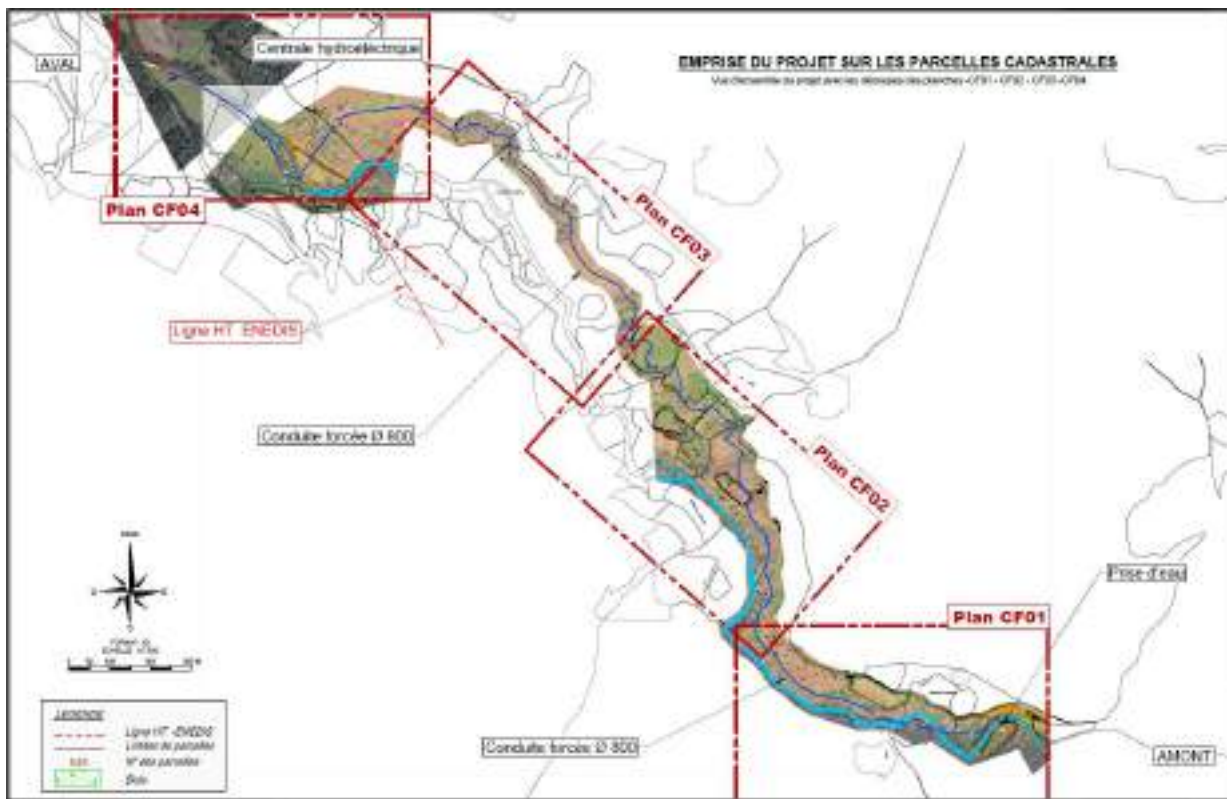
Plan d'implantation du projet - extrait plan GEN01
